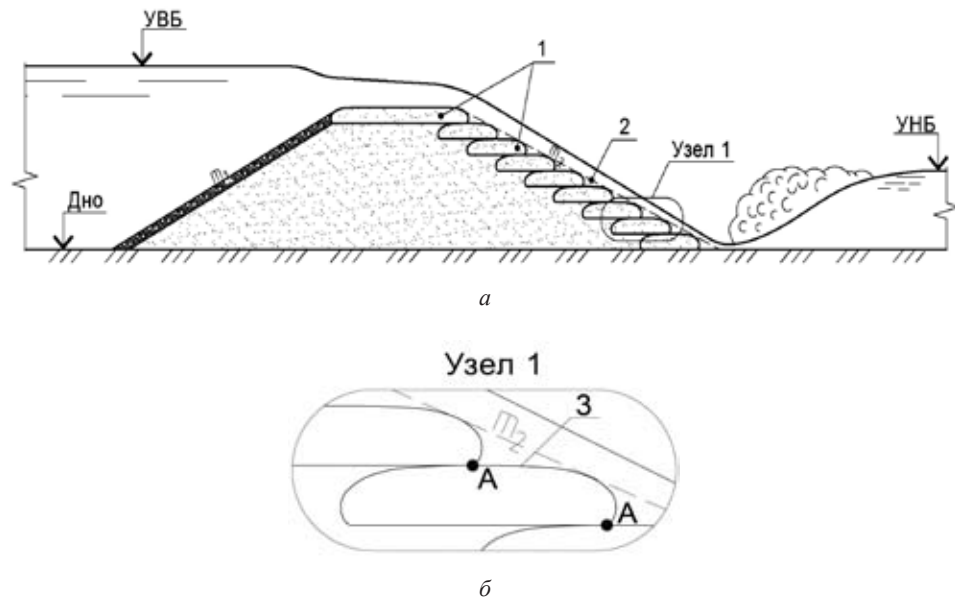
Схема конструкции грунтового переливного водоподпорного сооружения: *а* – поперечный профиль; *б* – схема укладки геосинтетических оболочек; 1 – геосинтетические оболочки; 2 – фильтр из геотекстиля; 3 – тело водоподпорного сооружения; 4 – засыпка
